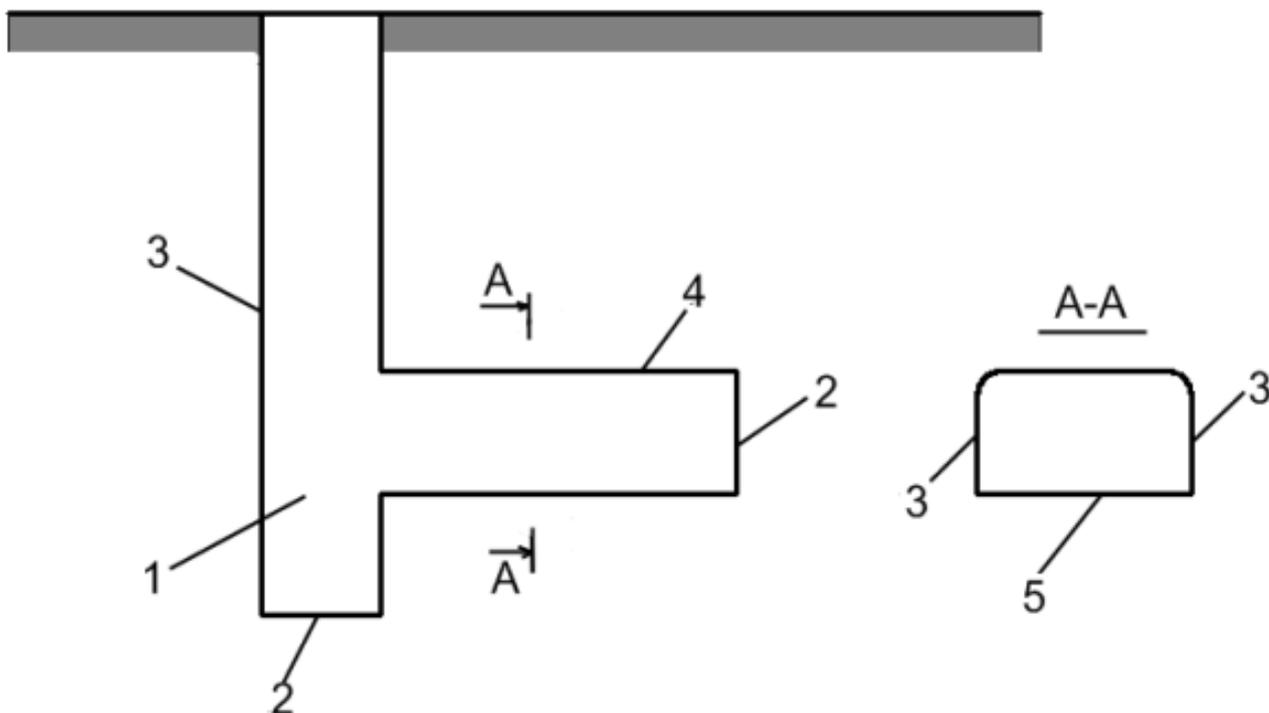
Элементы горных выработок: 1 – устье; 2 – забои; 3 – стенки (бока); 4 – кровля; 5 – почва (подошва)
